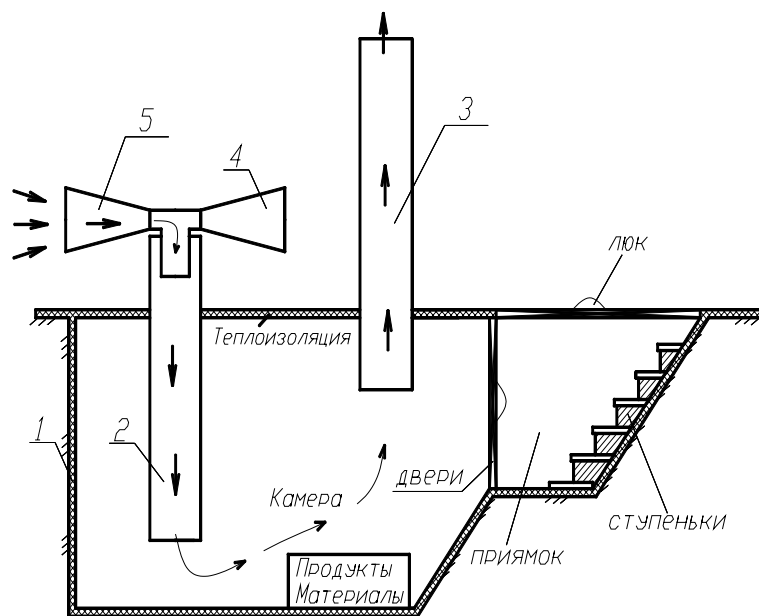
Холодильная камера в грунте без освещения (патент РБ №5073):
